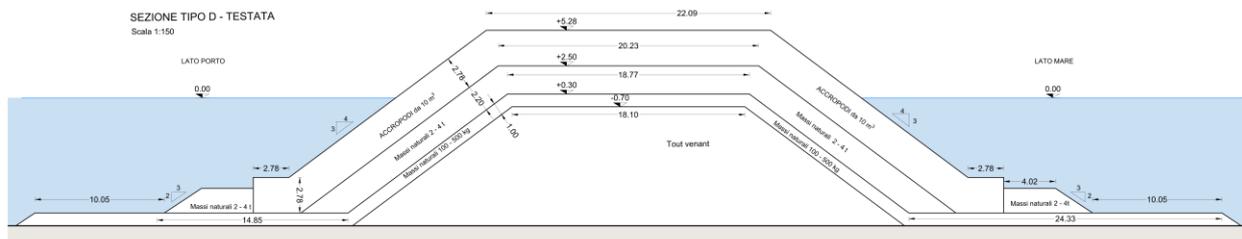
Sezione tipo D del Prolungamento della Diga Foranea Sud
